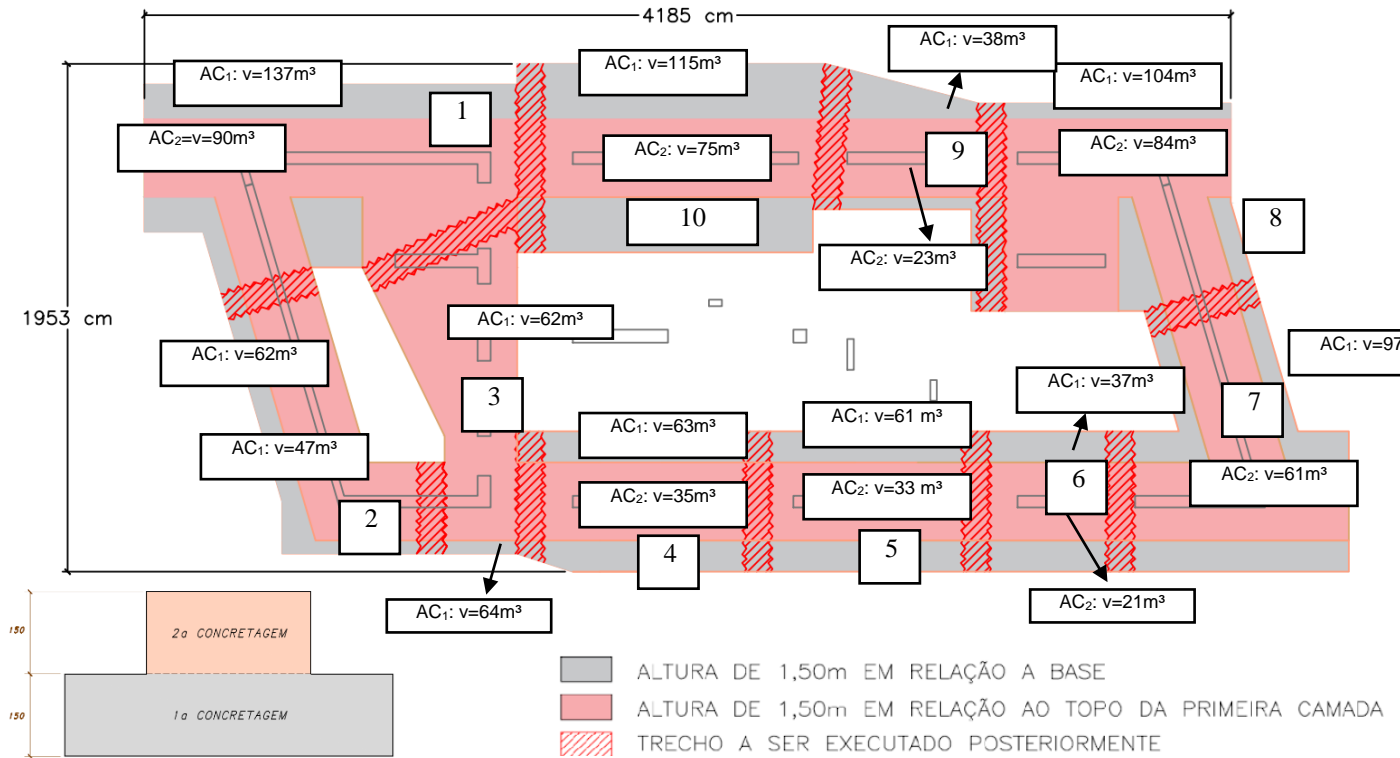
Detalhe da planta da sapata com indicação da sua divisão em etapas de menor volume (< 150 m³) e altura (AC=1,5m) – Notar a previsão de juntas verticais (trecho a ser executado posteriormente) para lançamento do concreto com retração compensada
